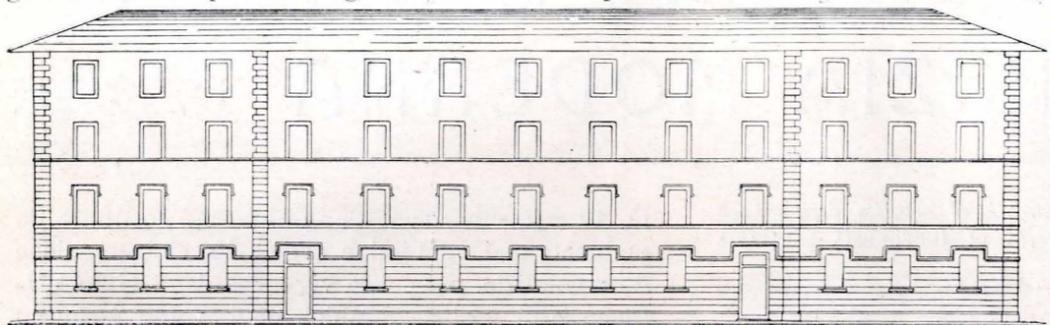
Prospetto geometrico dell'edificio A (scala 1:400).
